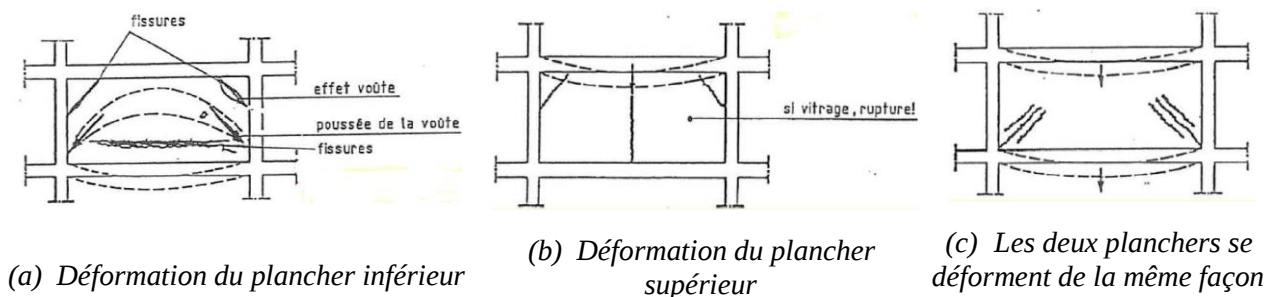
Fissuration de la maçonnerie résultant des déformations des planchers [20].
